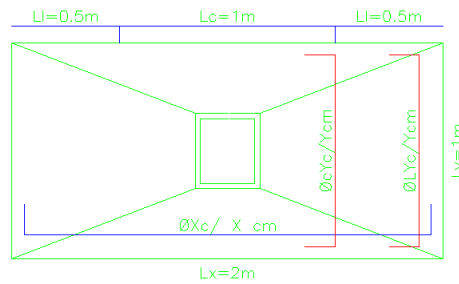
Ejemplo zapata con distribución de armadura central y lateral para la dirección Y, opción Plantas. Fuente: elaboración propia
